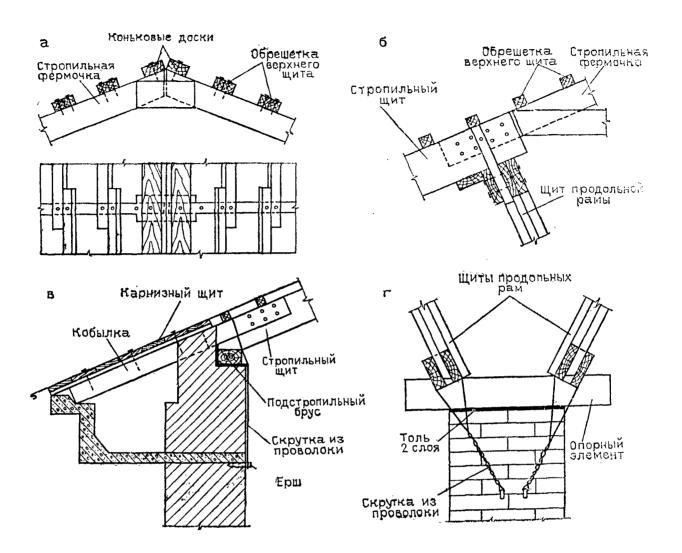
Детали сборных стропил a — коньковый узел; o — опирание фермочки на стропильный щит; o — карнизный щит; o — срединй опорный узел
